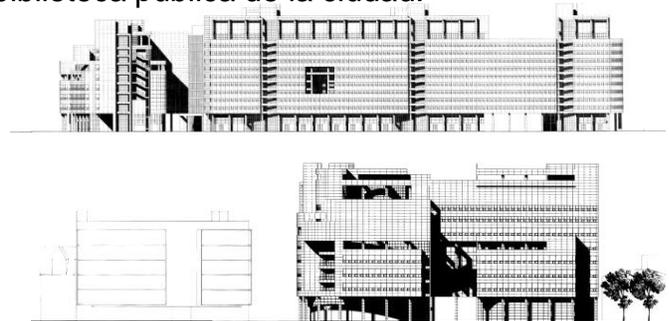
Referente Planimetría –. Fuente: <http://www.archdaily.co>
